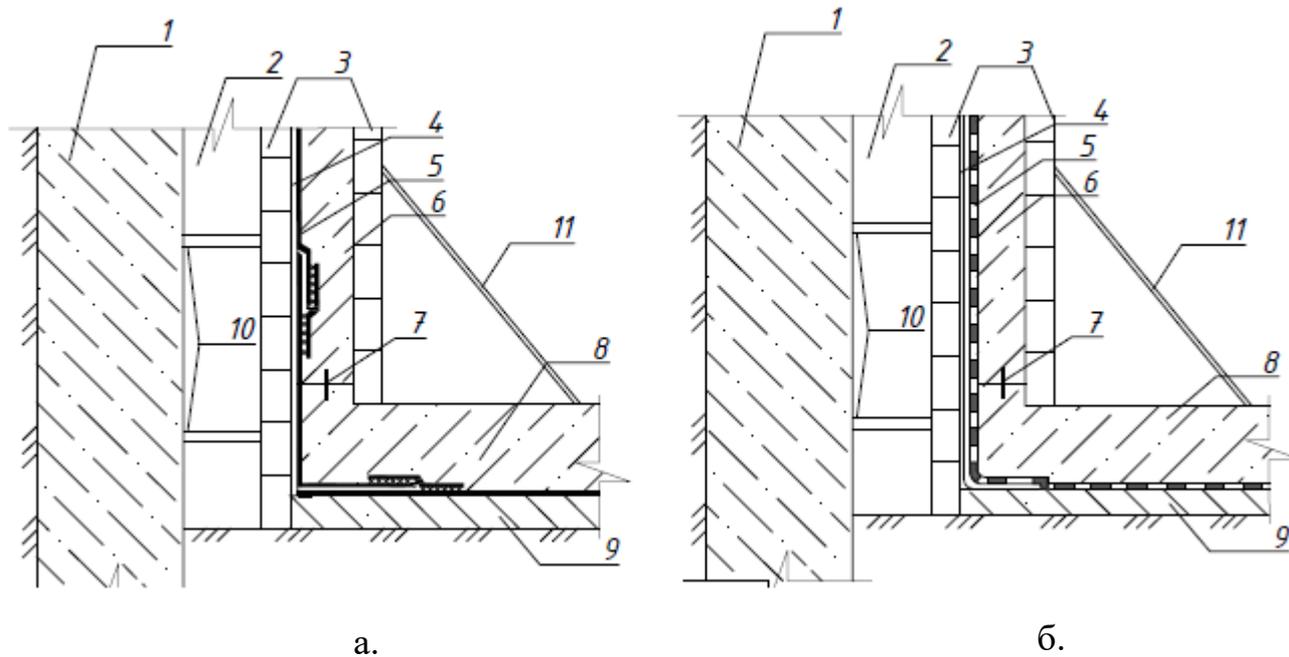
Гидроизоляция конструкций с пазухами для обратной засыпки грунта: а) гидроизоляционное покрытие из рулонов заводского изготовления, б) гидроизоляционное покрытие из напыляемых составов
